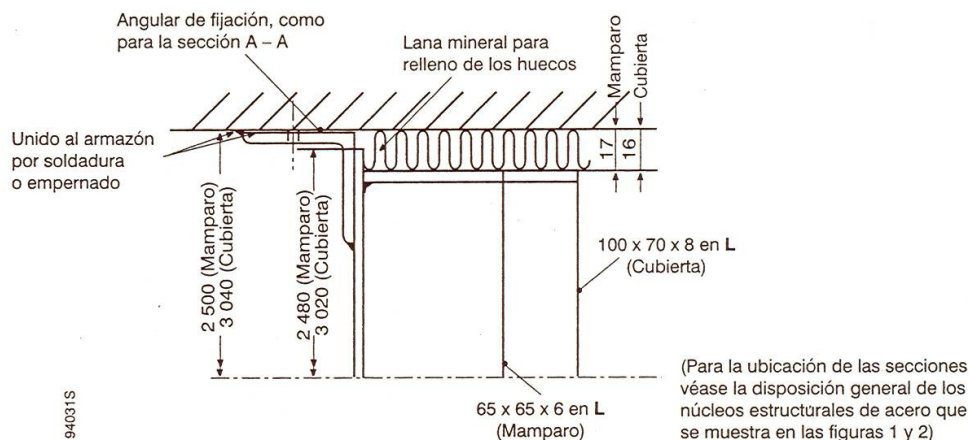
Conexión entre el armazón de sujeción y el núcleo estructural de acero
